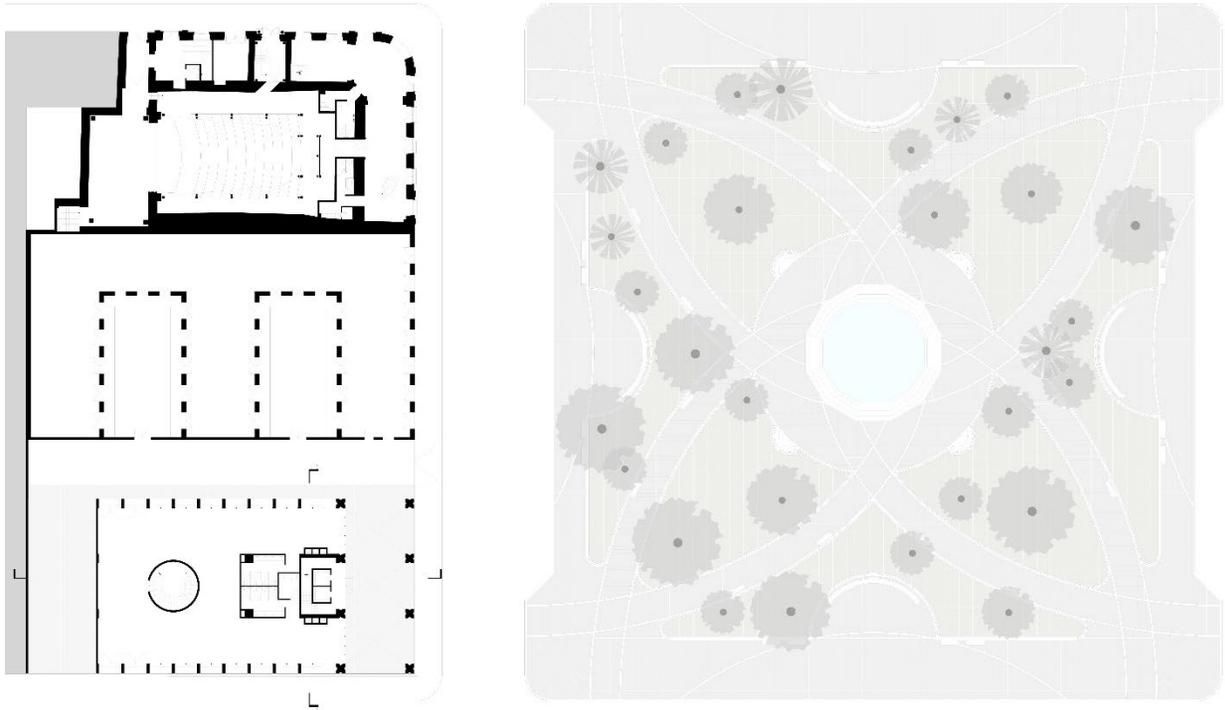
Planta baja general actual N ± 0.00. Fuente: Tesistas.
